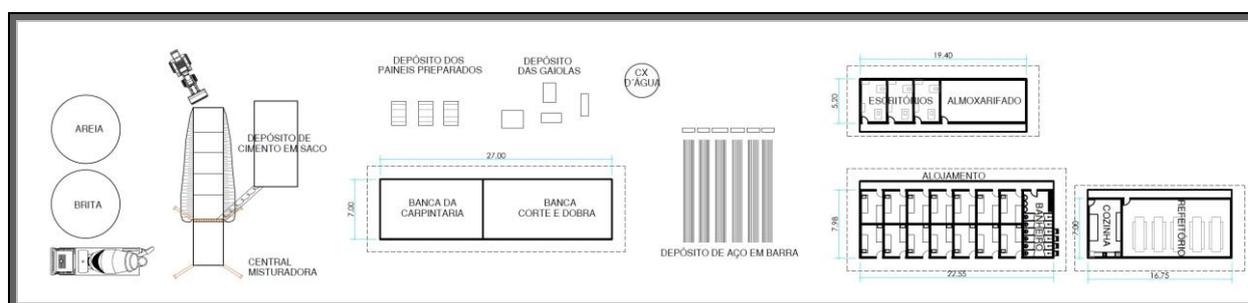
Esboço da disposição de um canteiro de obras para a PCH Cavernoso V.
